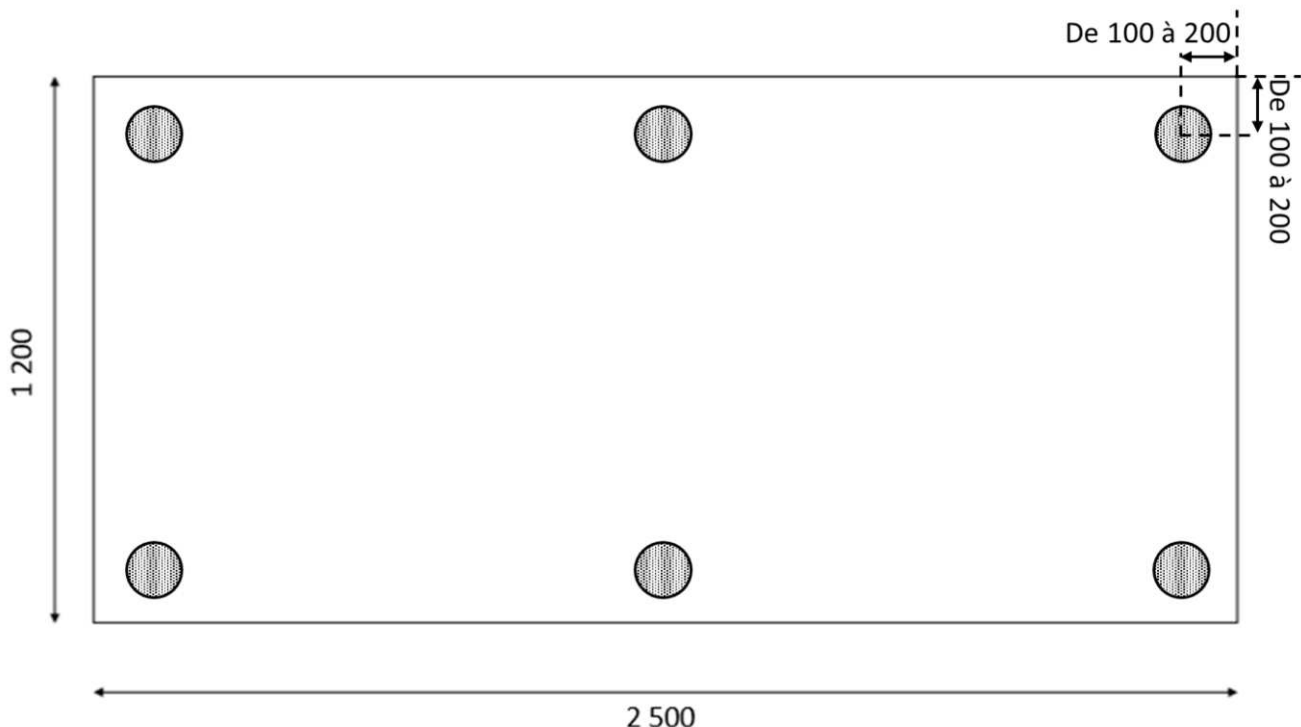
Implantation des fixations sur les panneaux Knauf SteelThane (dimensions en mm)
